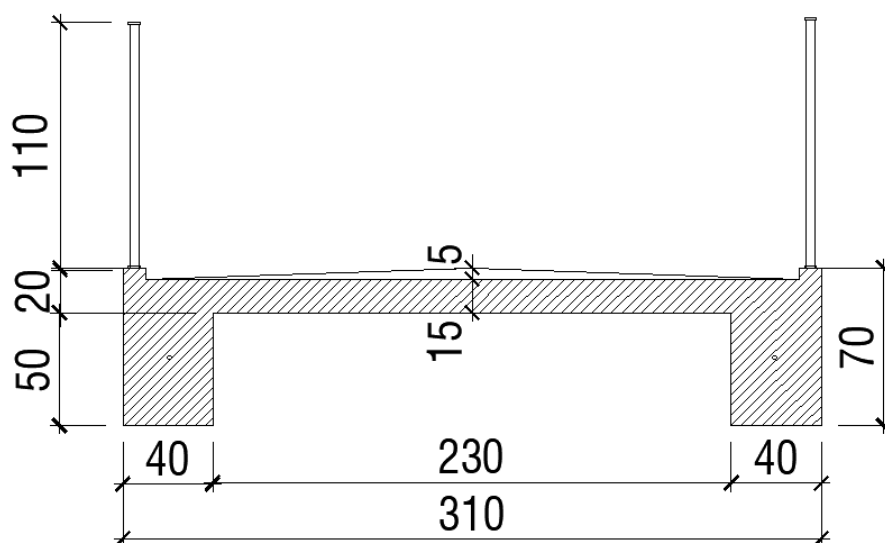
Seção do vão central (adaptado de Barros, 2009)
